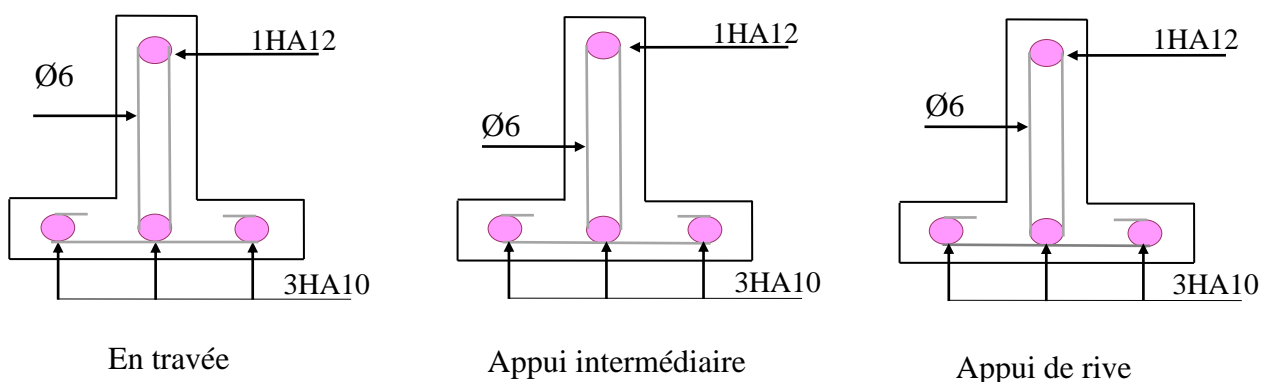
Schéma de Ferrailage des poutrelles plancher étage (Type3).
